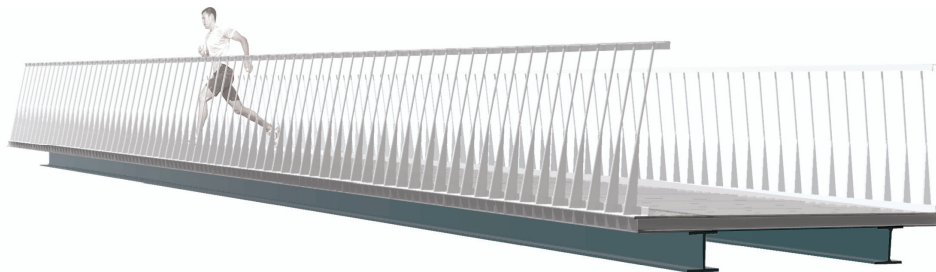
Modelo 3D de ponte pedonal com tabuleiro híbrido – painéis multicelulares de GFRP / vigas de aço.
